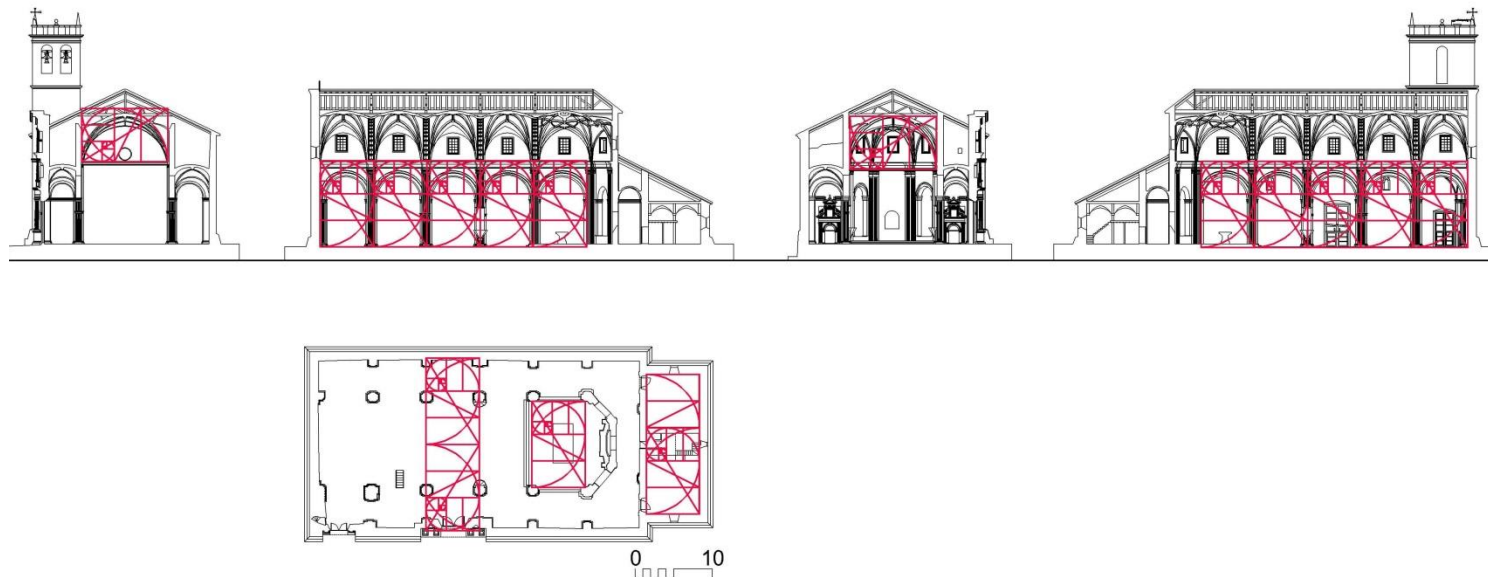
Sección áurea sobre algunos elementos constructivos.
